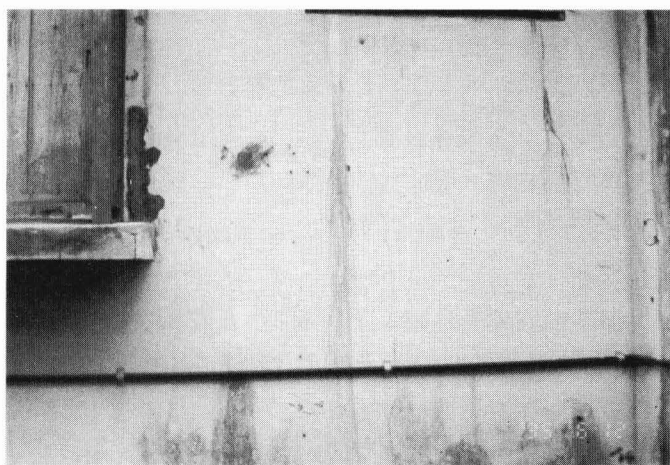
安謝団地A棟壁の縦ひび割れの損傷状況
